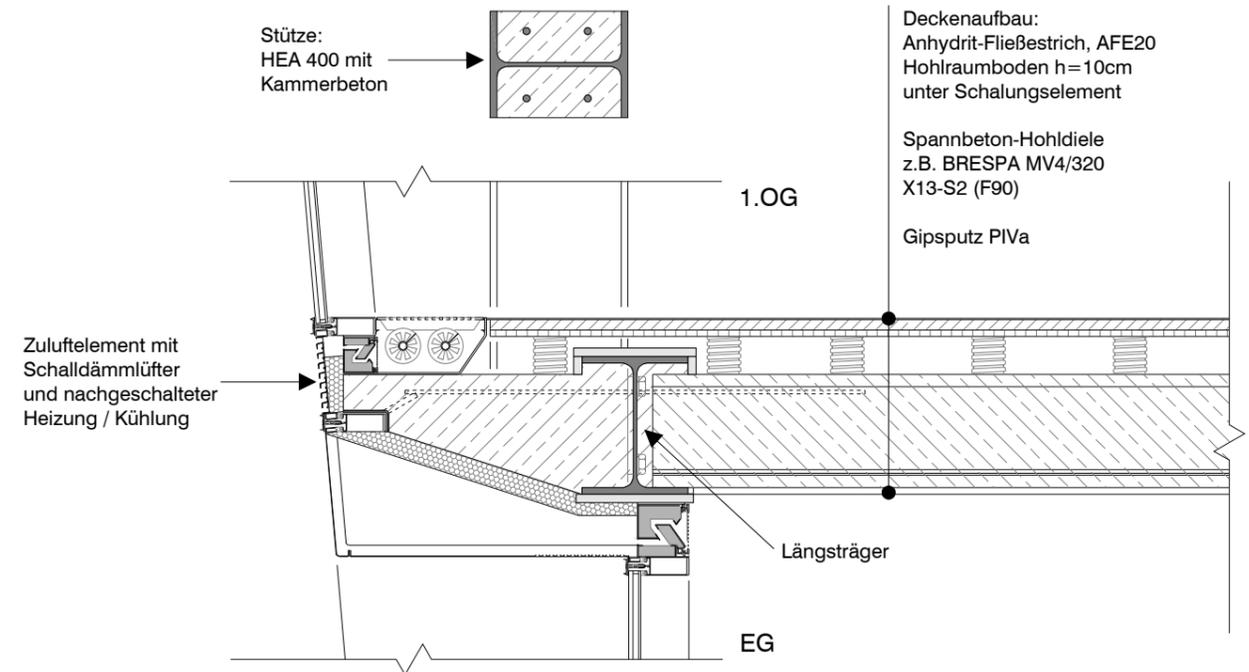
Detailschnitt Fassadenanschluß M 1 : 25
